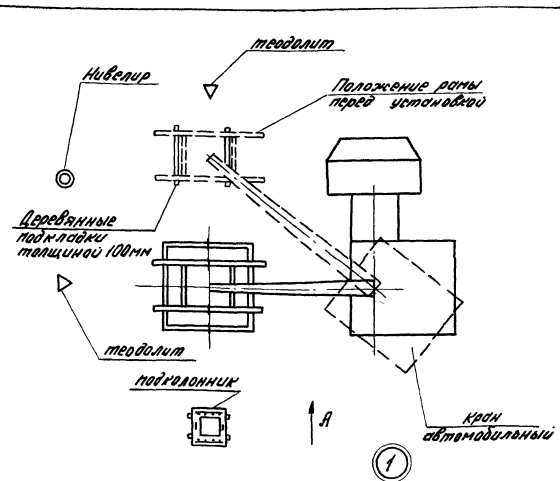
Схема установки монтажной рамы на опалудку плиты ростверка
